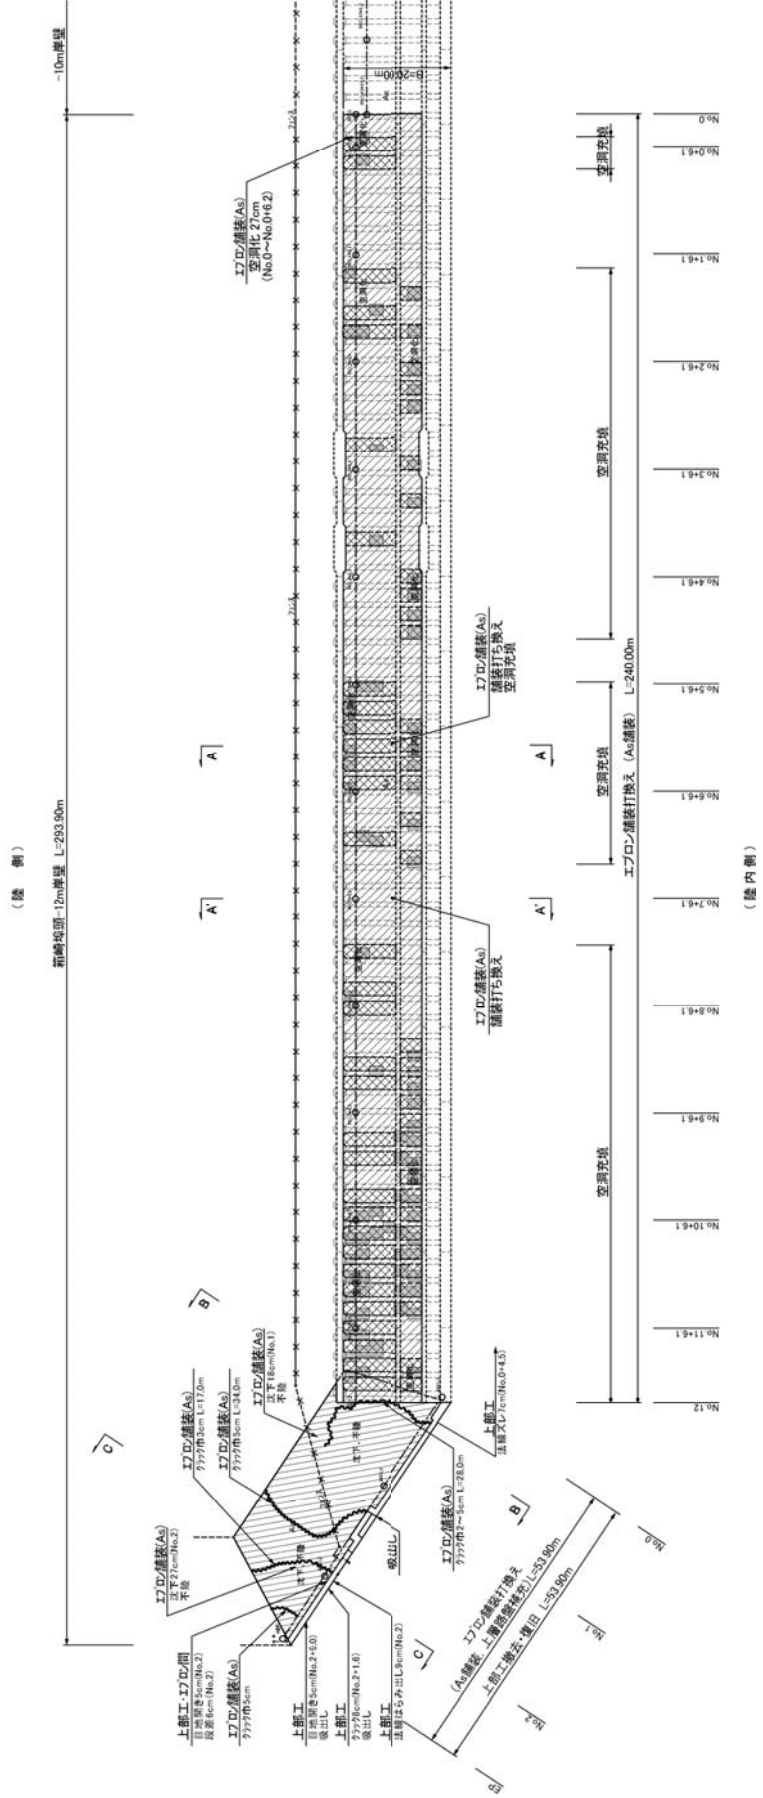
箱崎埠頭-12m 岸壁の被災・復旧平面図
